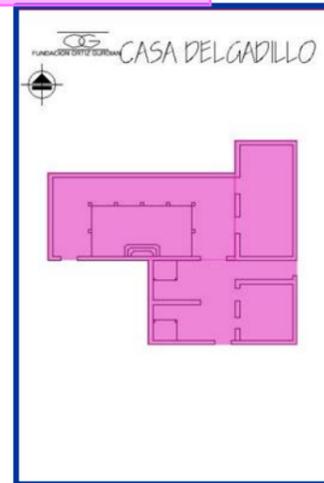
Plano Casa Delgadillo. Fuente: Propia
